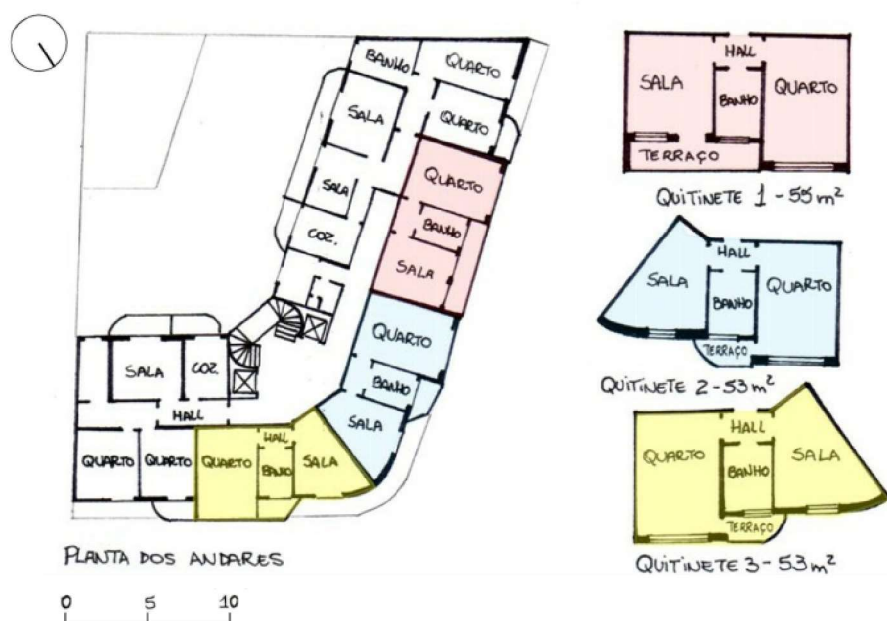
Reprodução da planta do Pavimento tipo do Edifício Livia Maria.
